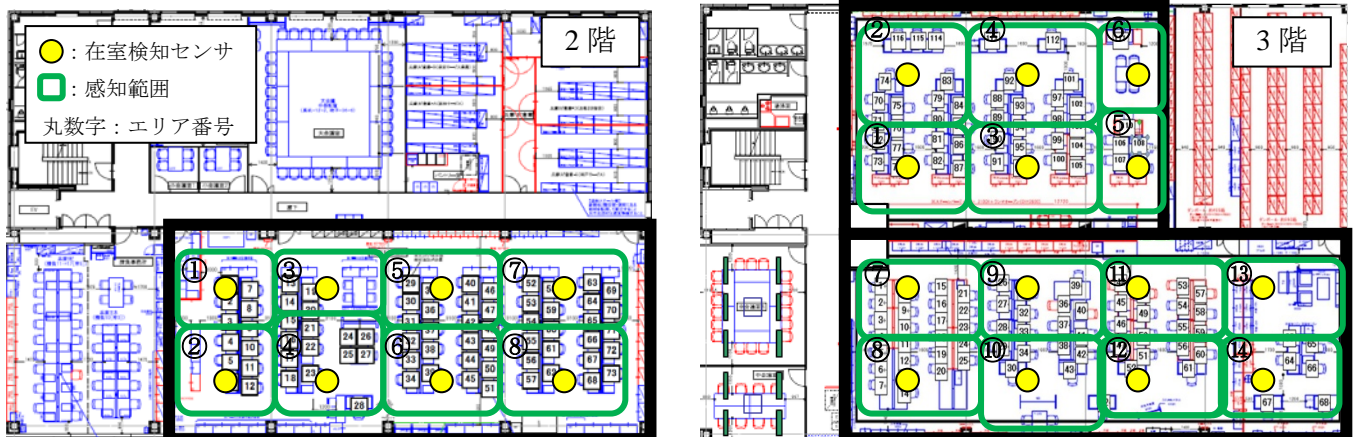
対象階平面図及び在室検知センサ設置位置（太枠：執務室）
